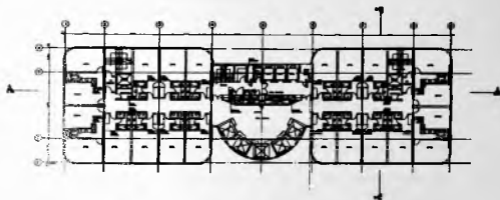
Planta Pav. Tipo - 4º ao 16º andar
